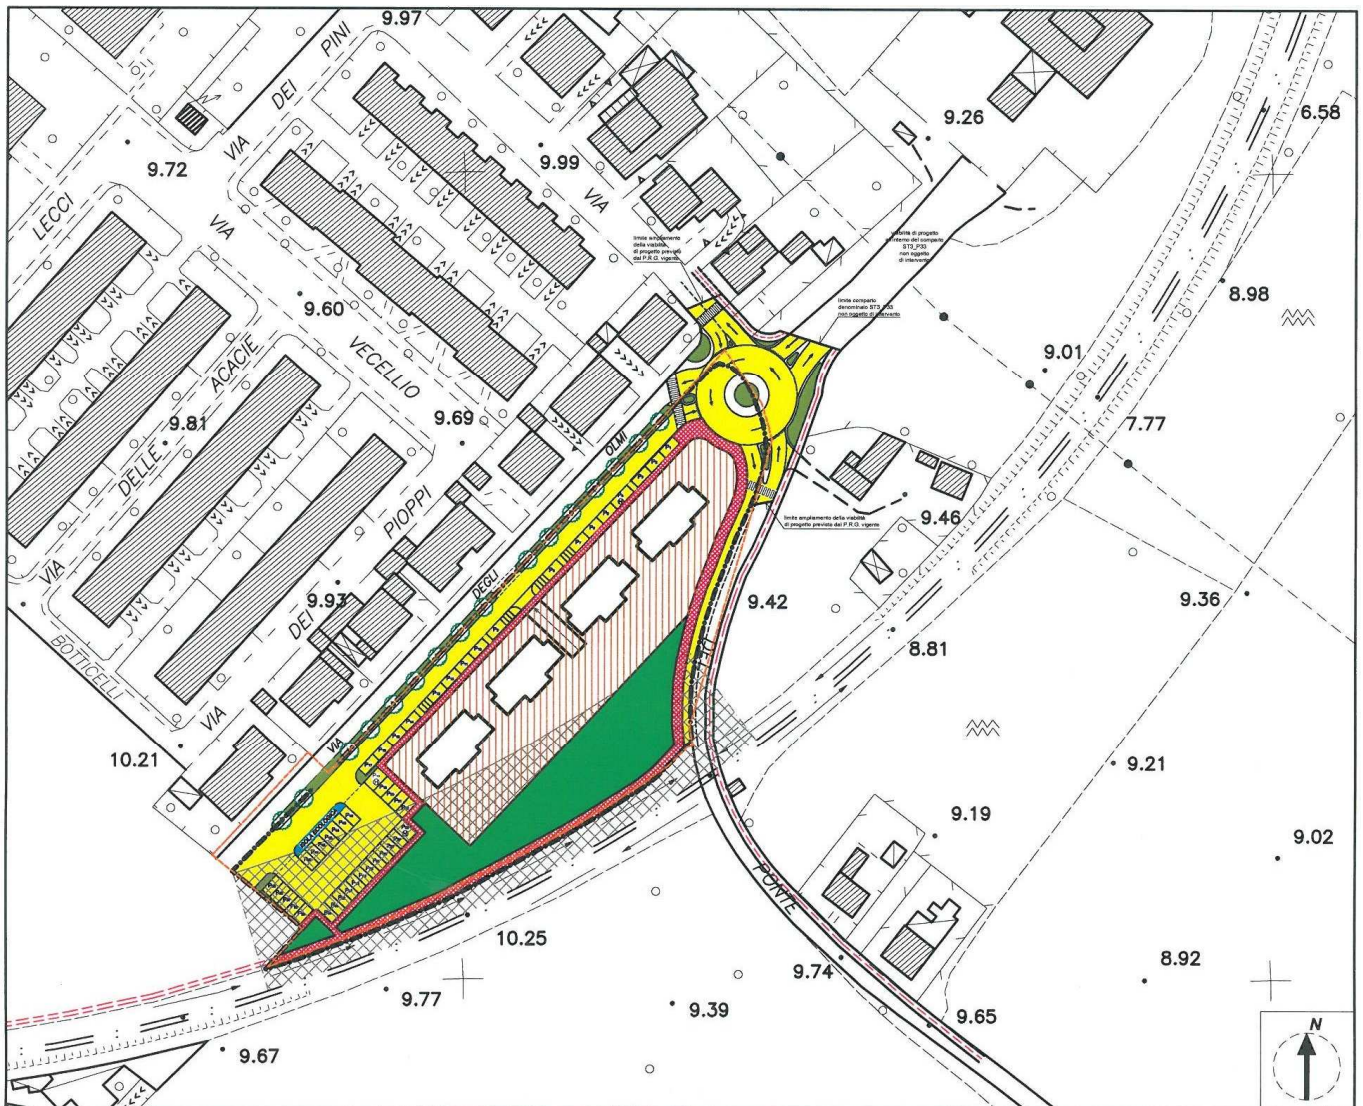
Planimetria di progetto dell'area oggetto della Variante
